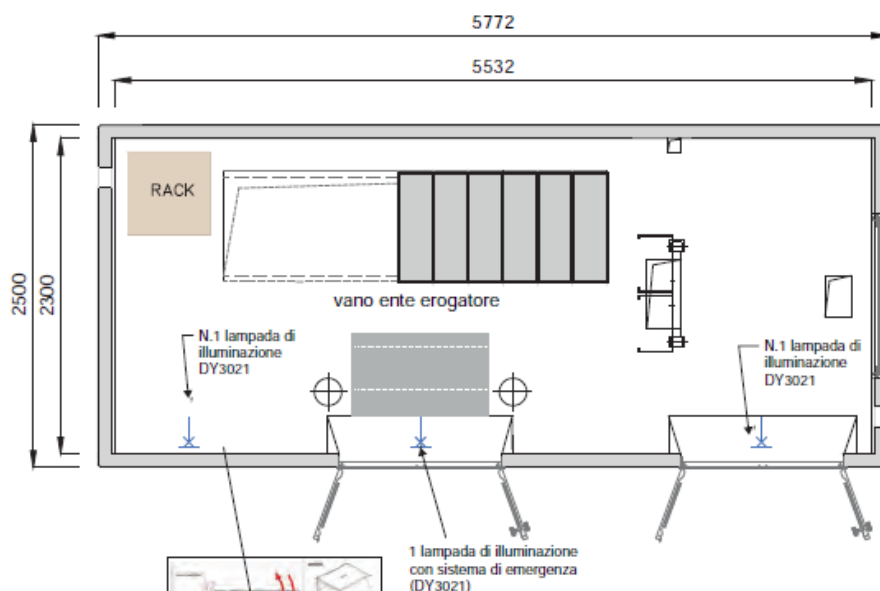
Tipologico Cabina di Sezionamento a installarsi
